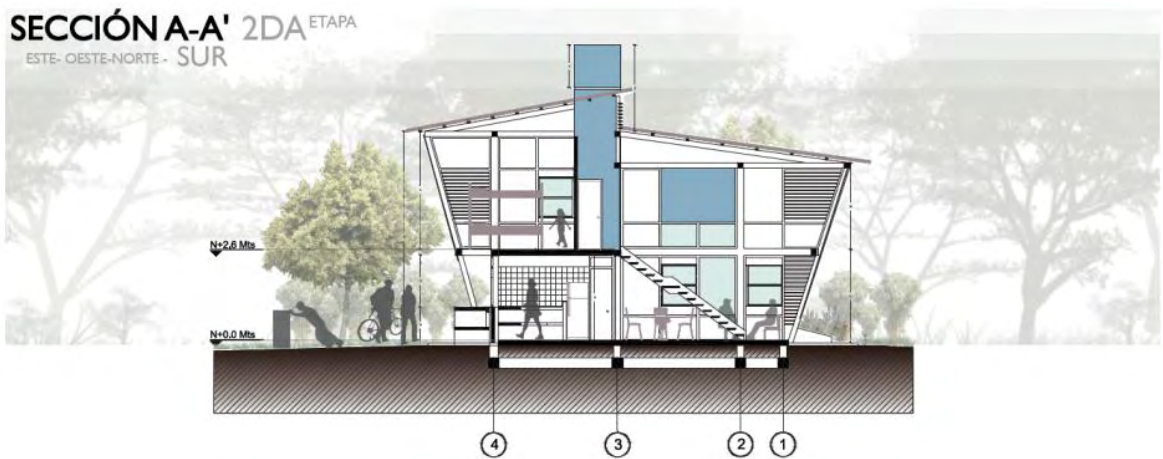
Sección 02, Corte A-A Norte A2 Fuente: propia
